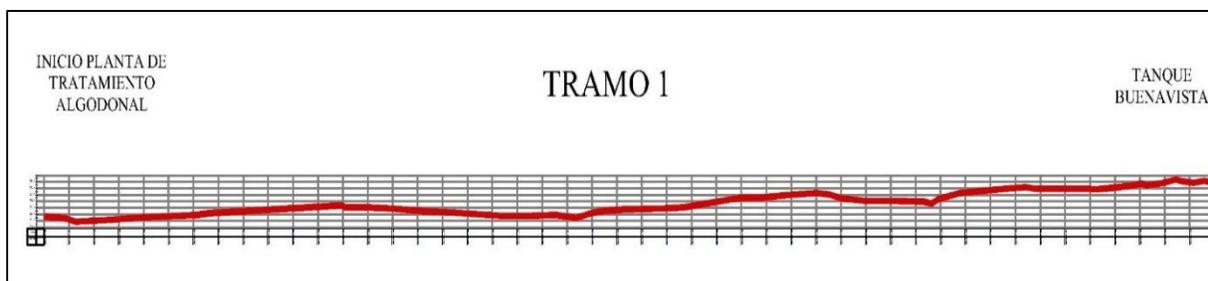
Perfil del terreno tramo planta de tratamiento Algodonal-Buena Vista. Fuente: Pasante del proyecto.
